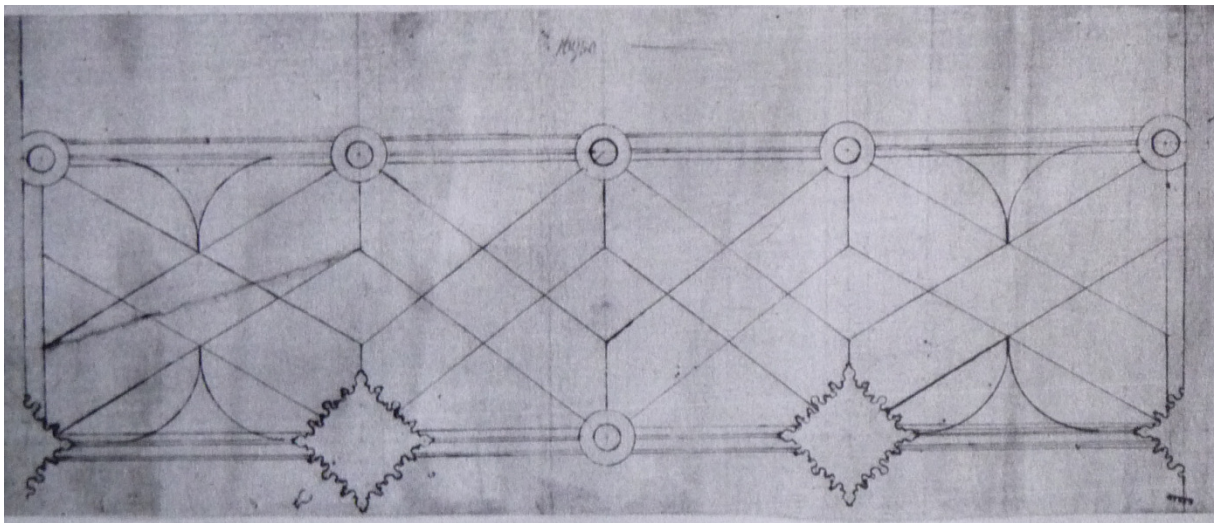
, Unbekannter Zeichner, Grundriss des Netzgewölbes im Lettner der Stadtpfarrkirche von Steyr, 15. Jahrhundert.
